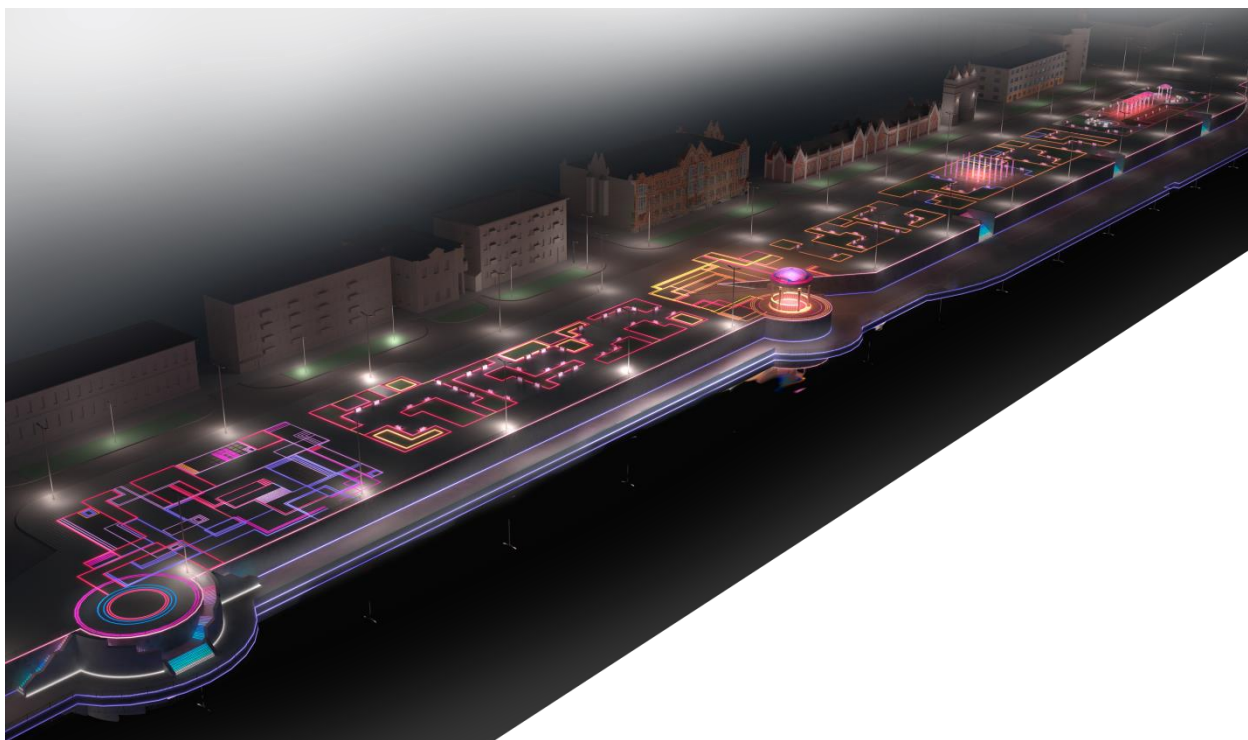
Вариант подсветки набережной в теплой гамме
